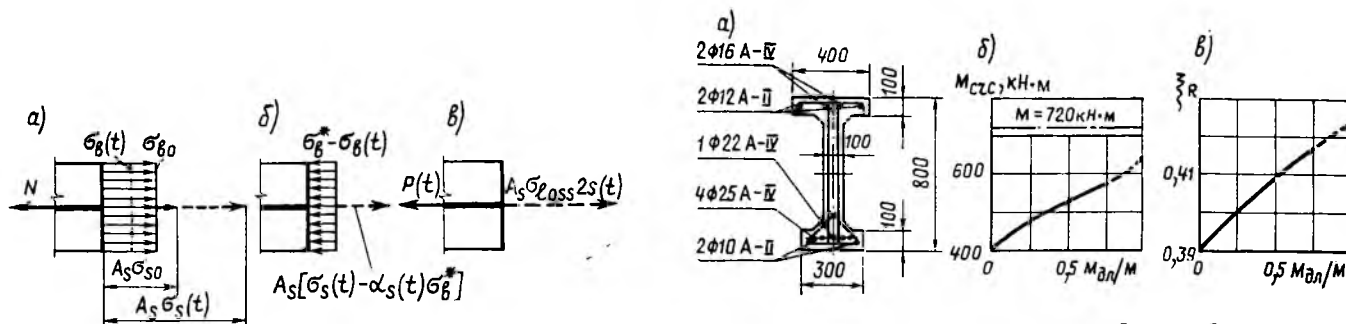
К примеру расчета преднапряженной железобетонной балки
